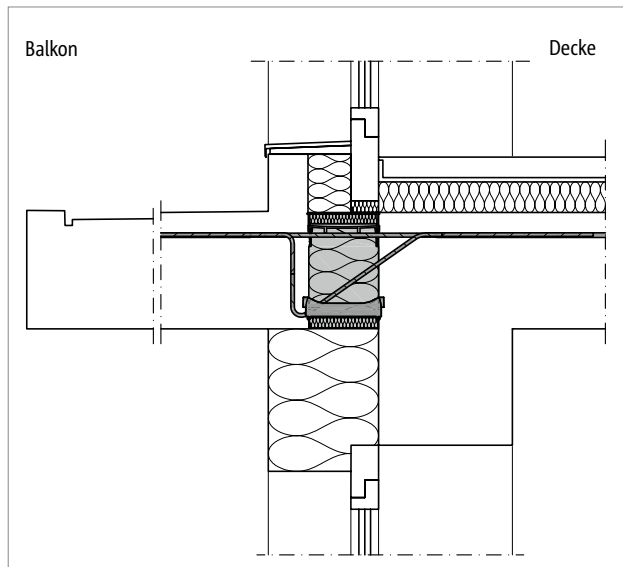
Schöck Isokorb® XT Typ K: Anschluss mit Fensterdetail oberhalb und unterhalb des Anschlusses
